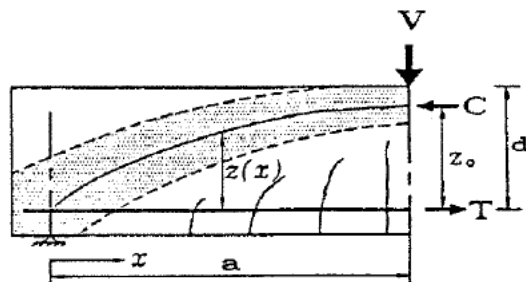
Equilibre des mécanismes poutre et arche (Kim, and White 1999)
